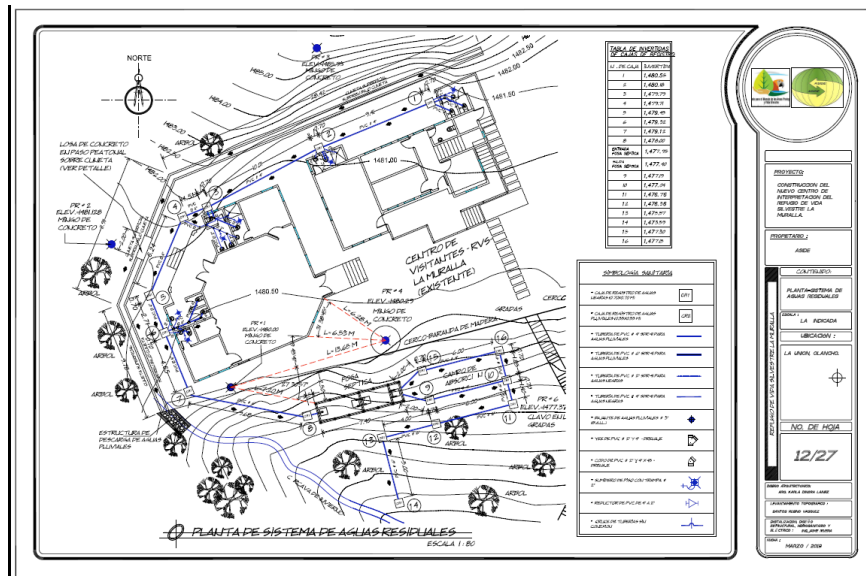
Planos de parque Nacional La Muralla, Olancho
